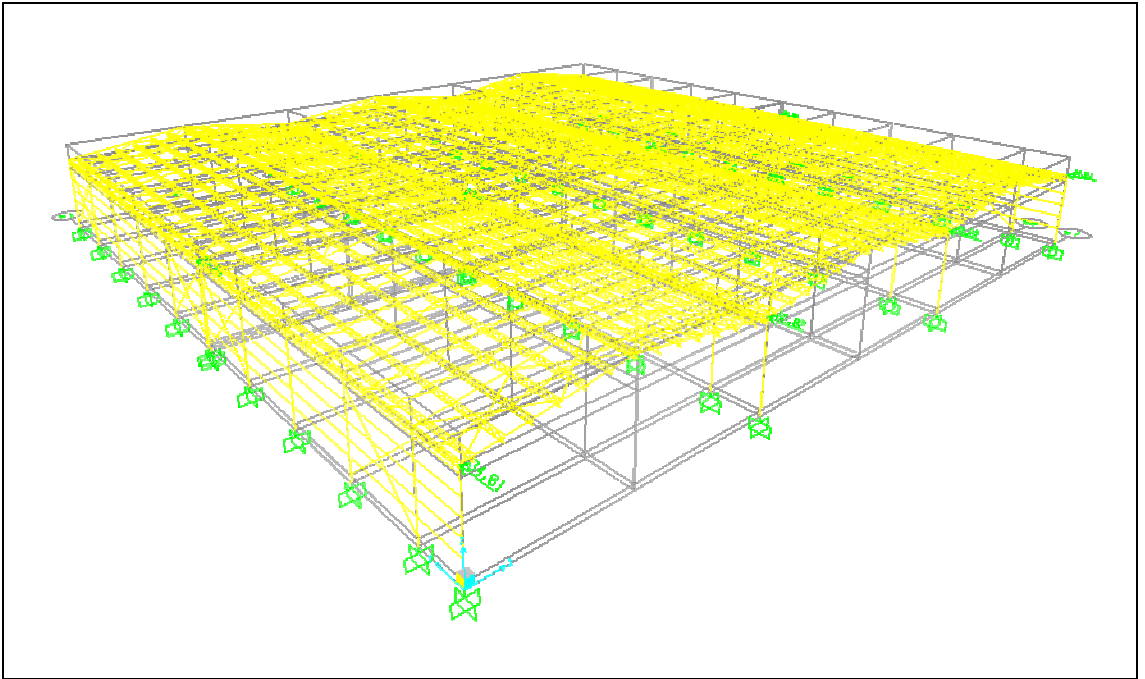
Kolon ve kirişlere etkiyen x yönü rüzgar yükleri
